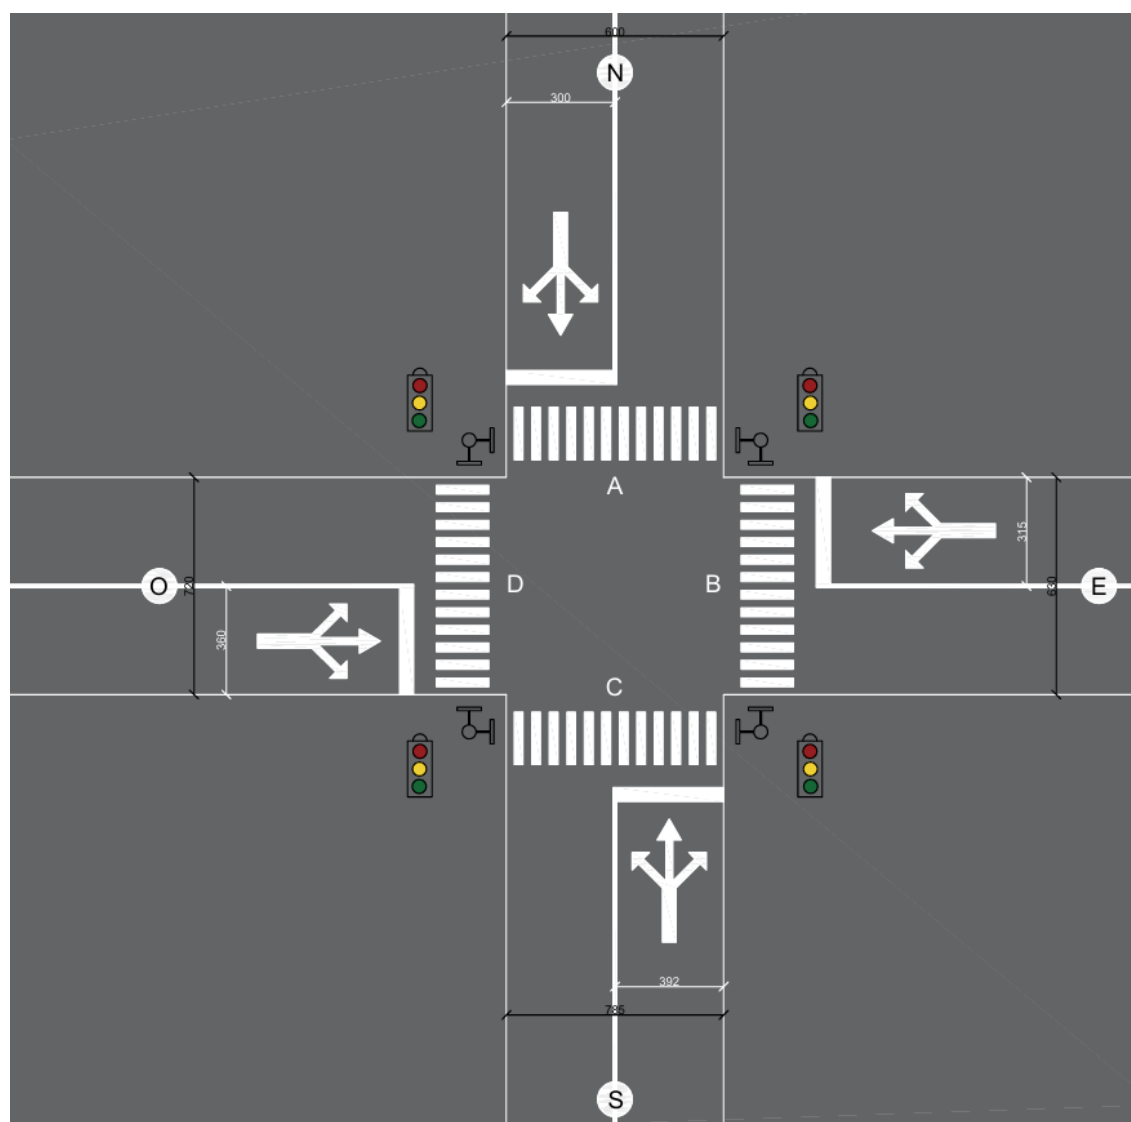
Schematizzazione dell'intersezione semaforizzata su via Sampietro
